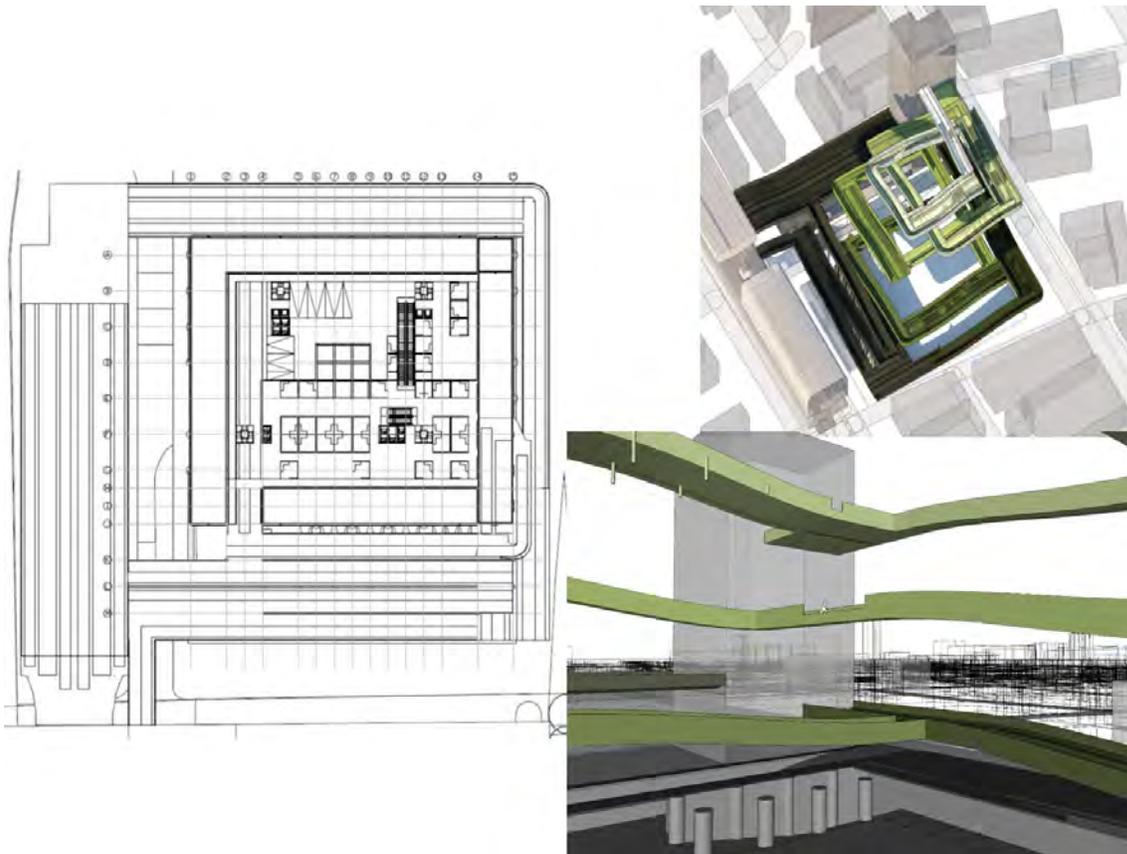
El Estrato Parque. La construcción de una rampa continua que articula elementos pre-existentes y el transporte masivo.
